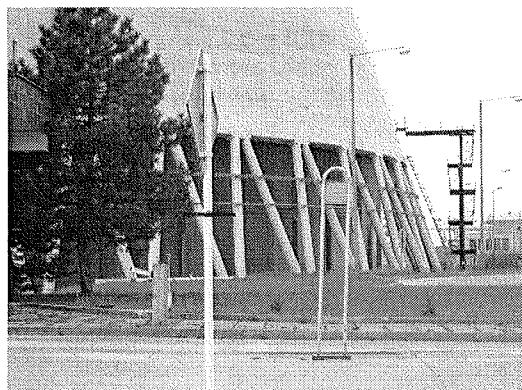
vzduchový ventilátor EMĚ III
